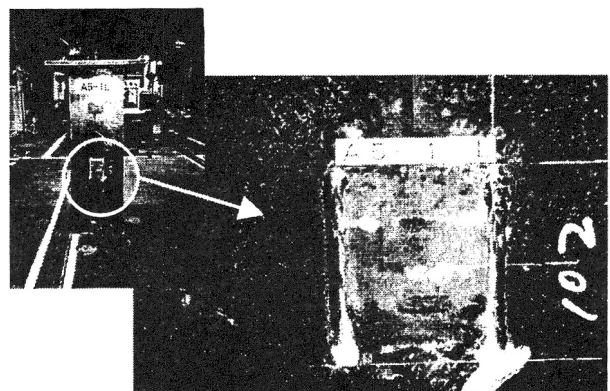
ジベル溶接部の破断状況 (供試体 A5-1)
